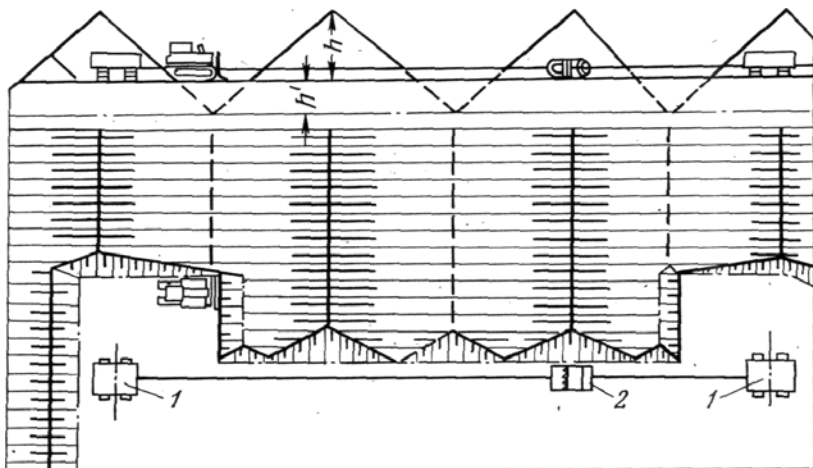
Планування поверхні відвалу за допомогою планувально-відвального пристрою
